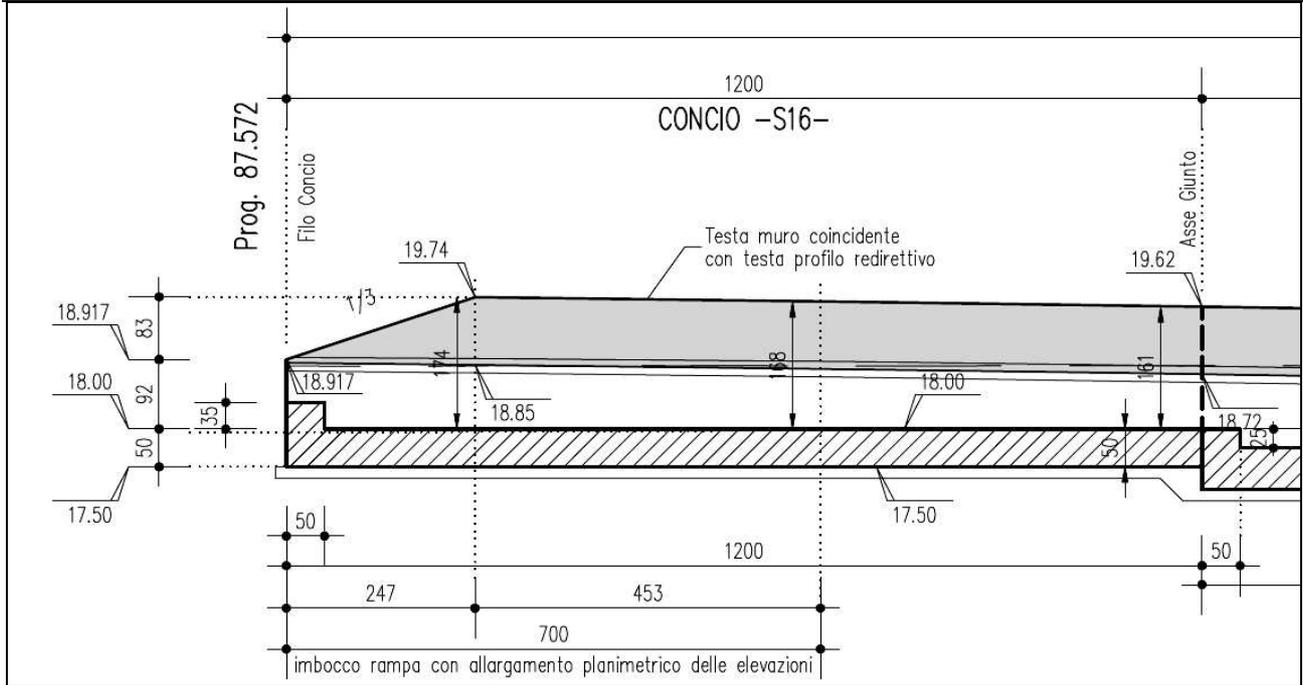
PARTICOLARE CONCIO SUD DI ESTREMITÀ
